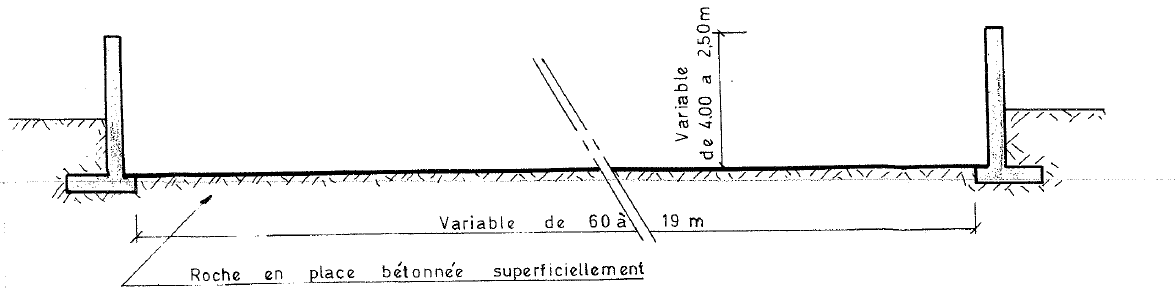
Coursier en béton, avec présence de bajoyers avec semelles en rives droite et gauche
